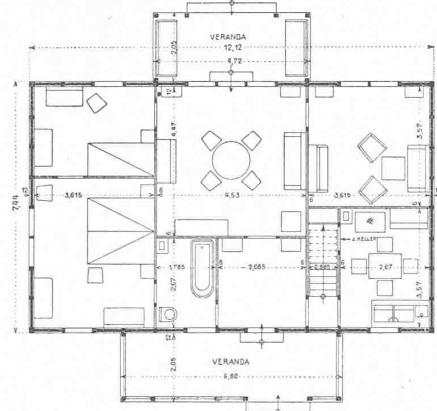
Grundriss-Typ 56 m². — Masstab 1:200. — Abb. 24 und 25. Grundriss-Typ 90 m² überbauter Grundfläche.
